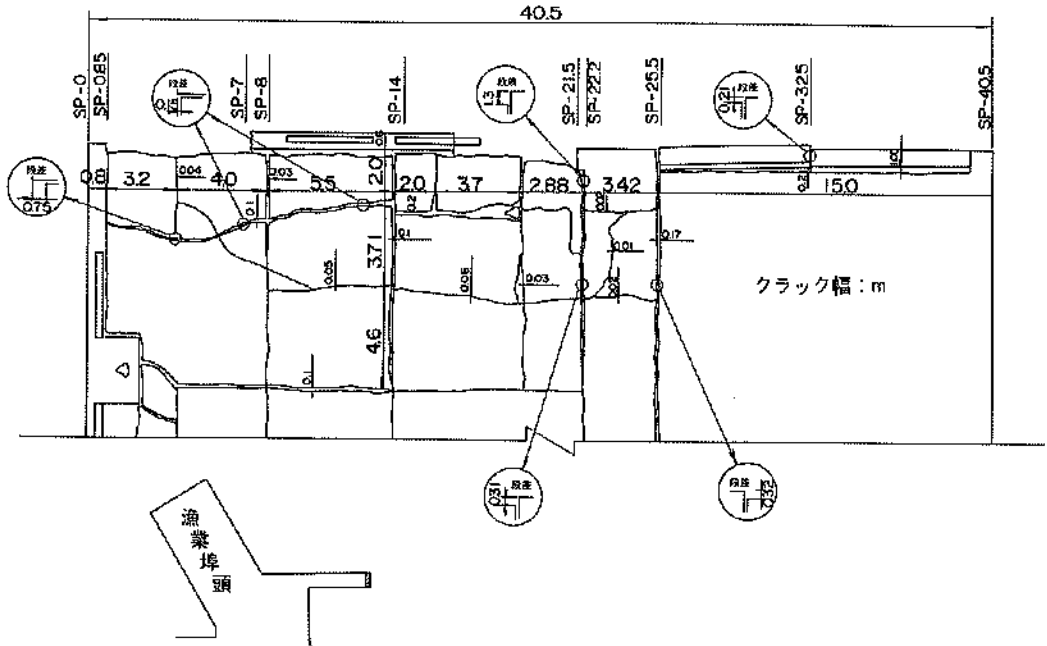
エプロンクラック平面図その2 (副港地区, ②③岸壁(-5.0m))
